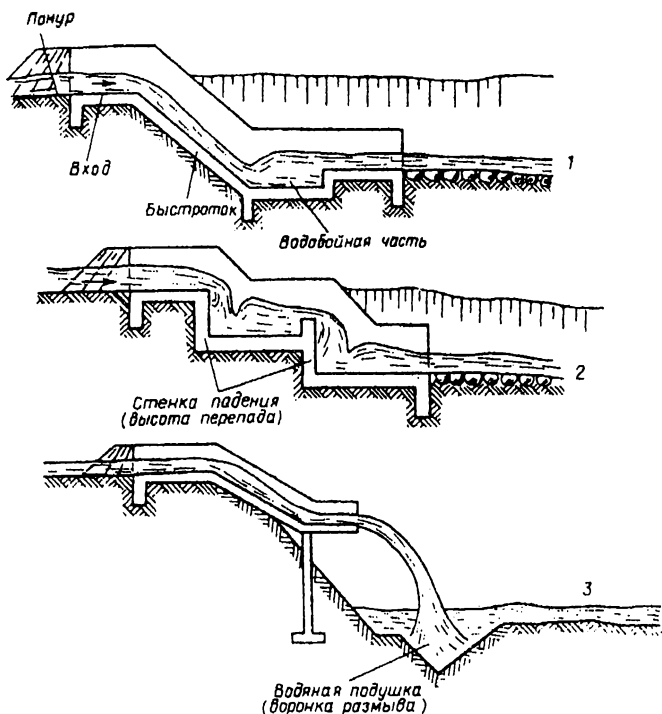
Схематическое изображение водосборных сооружений, применяемых при закреплении оврагов: 1 – быстроток; 2 – двухступенчатый перепад; 3 – консольный сброс
